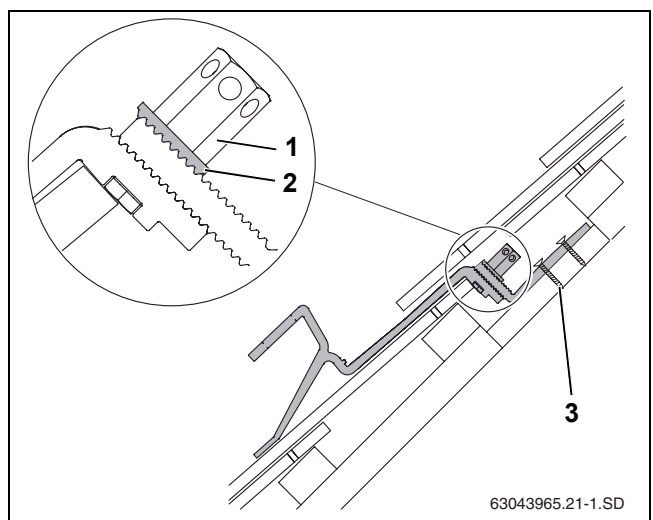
Gancho de tejado montado – vista de la sección con parte inferior del gancho de tejado acortada
